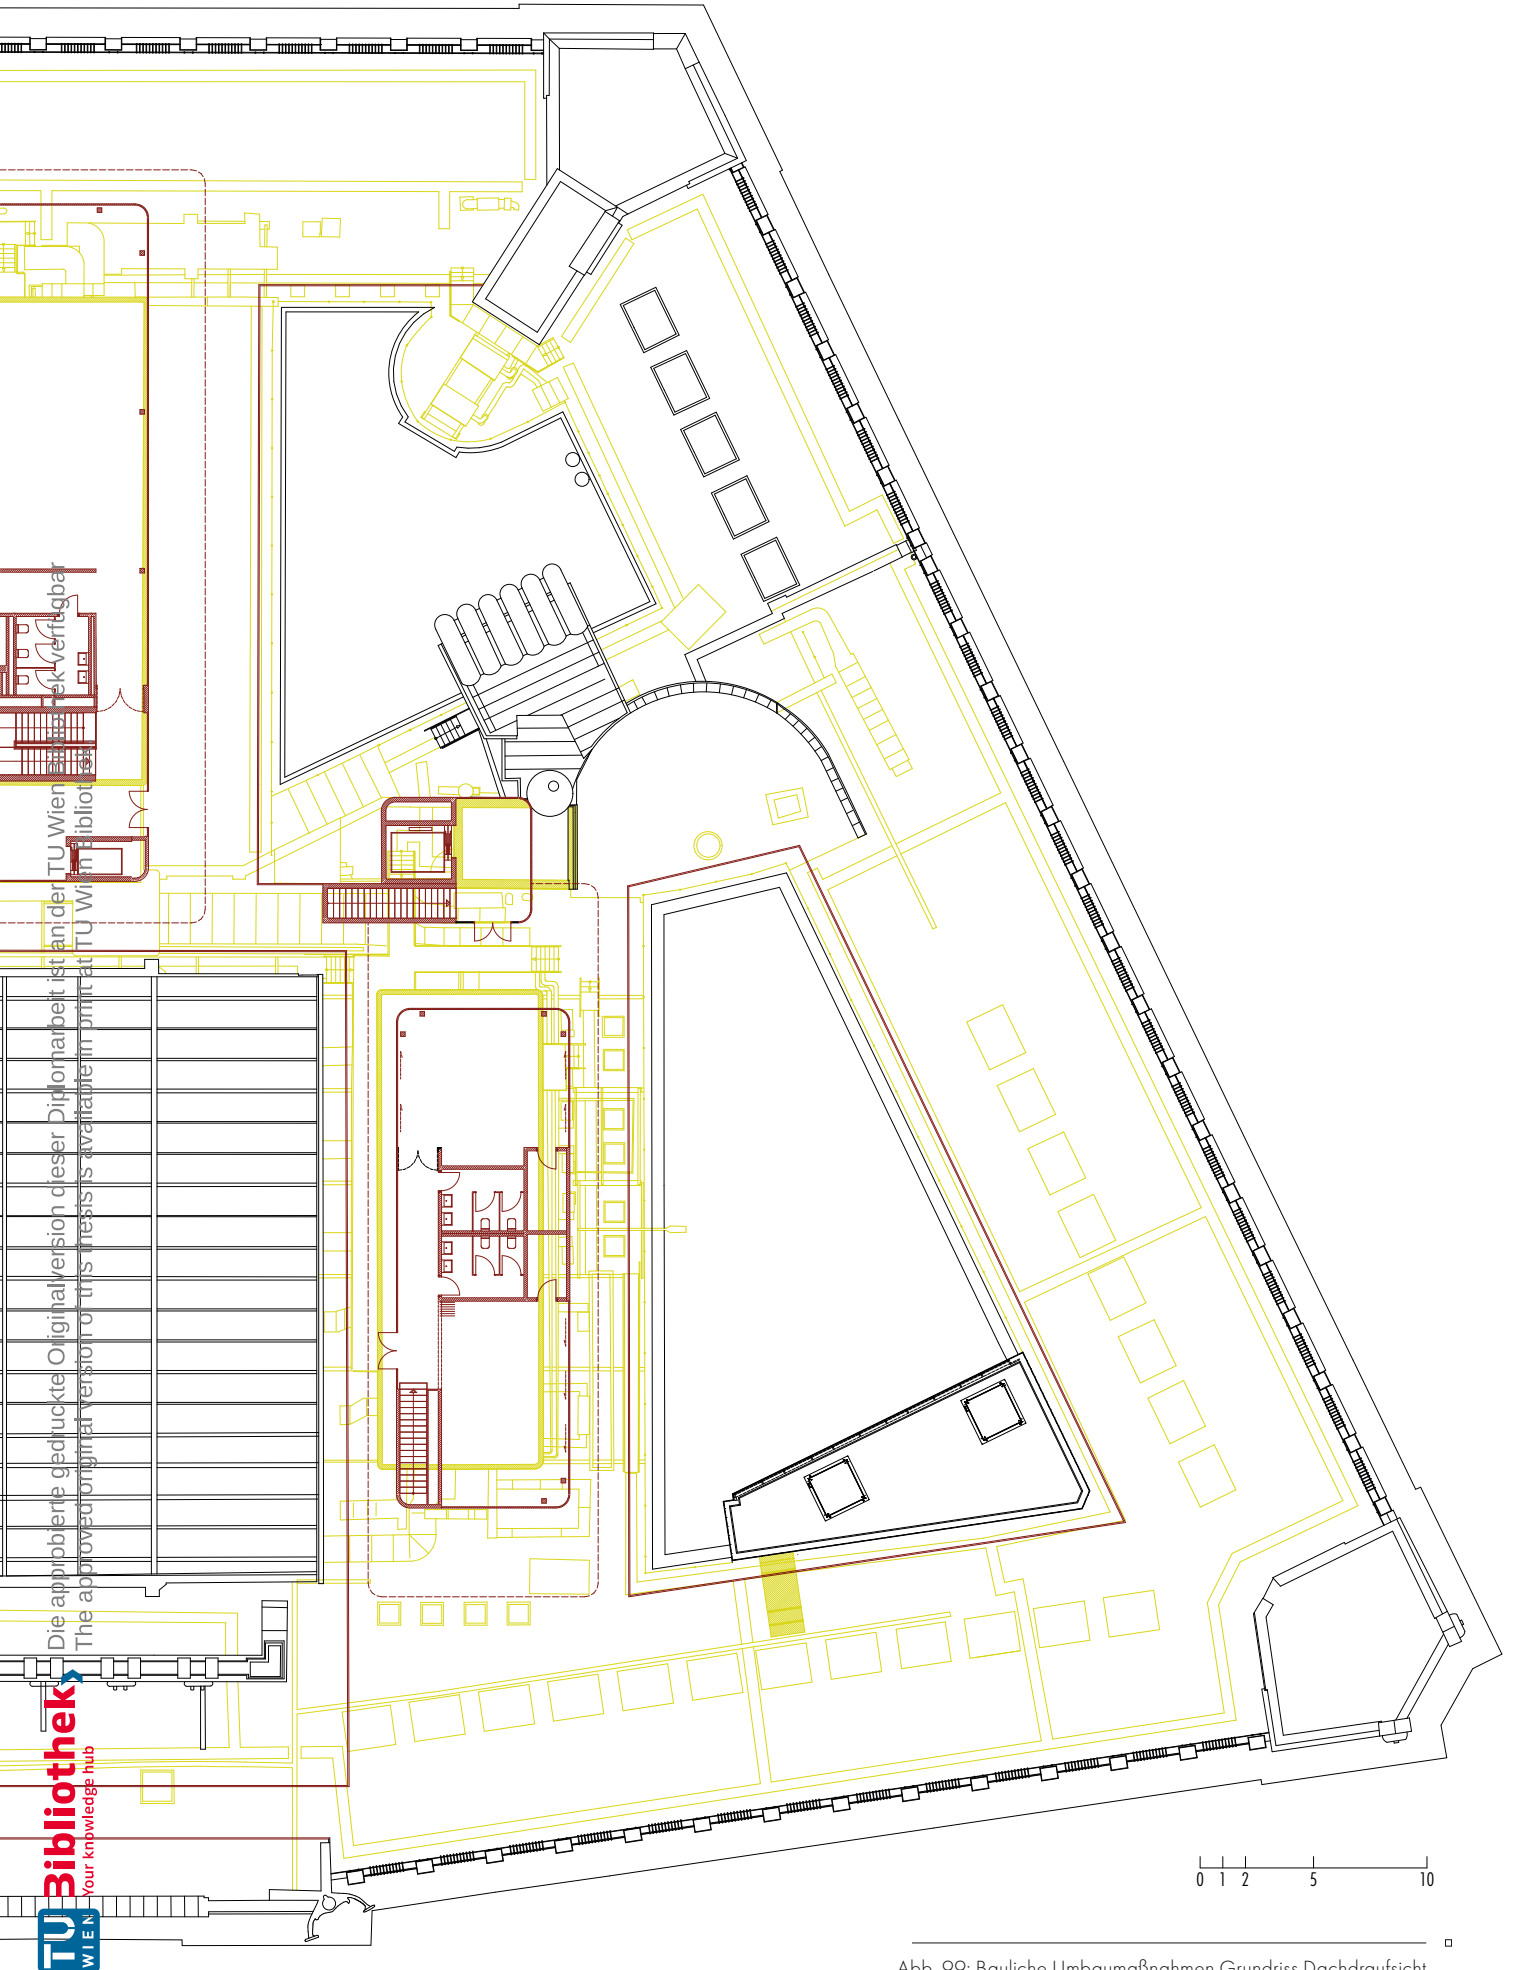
Entwurfsplan Grundriss Dachdrucksicht
